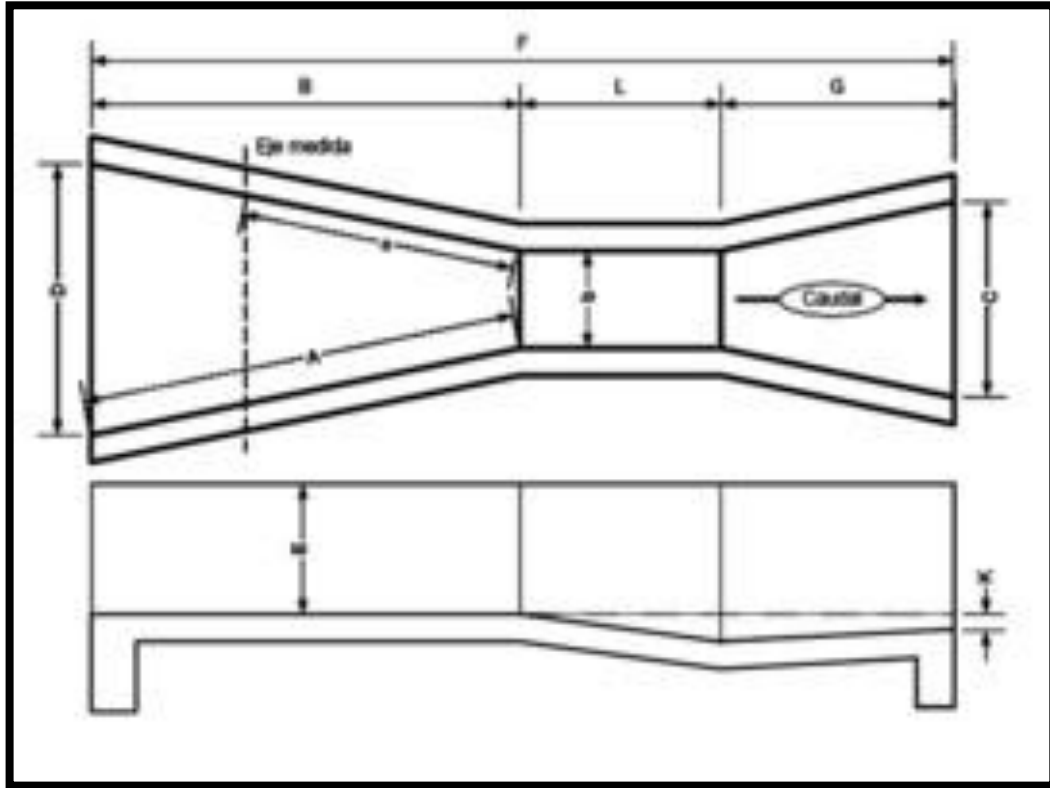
Canaleta parshall en planta y en corte longitudinal.
